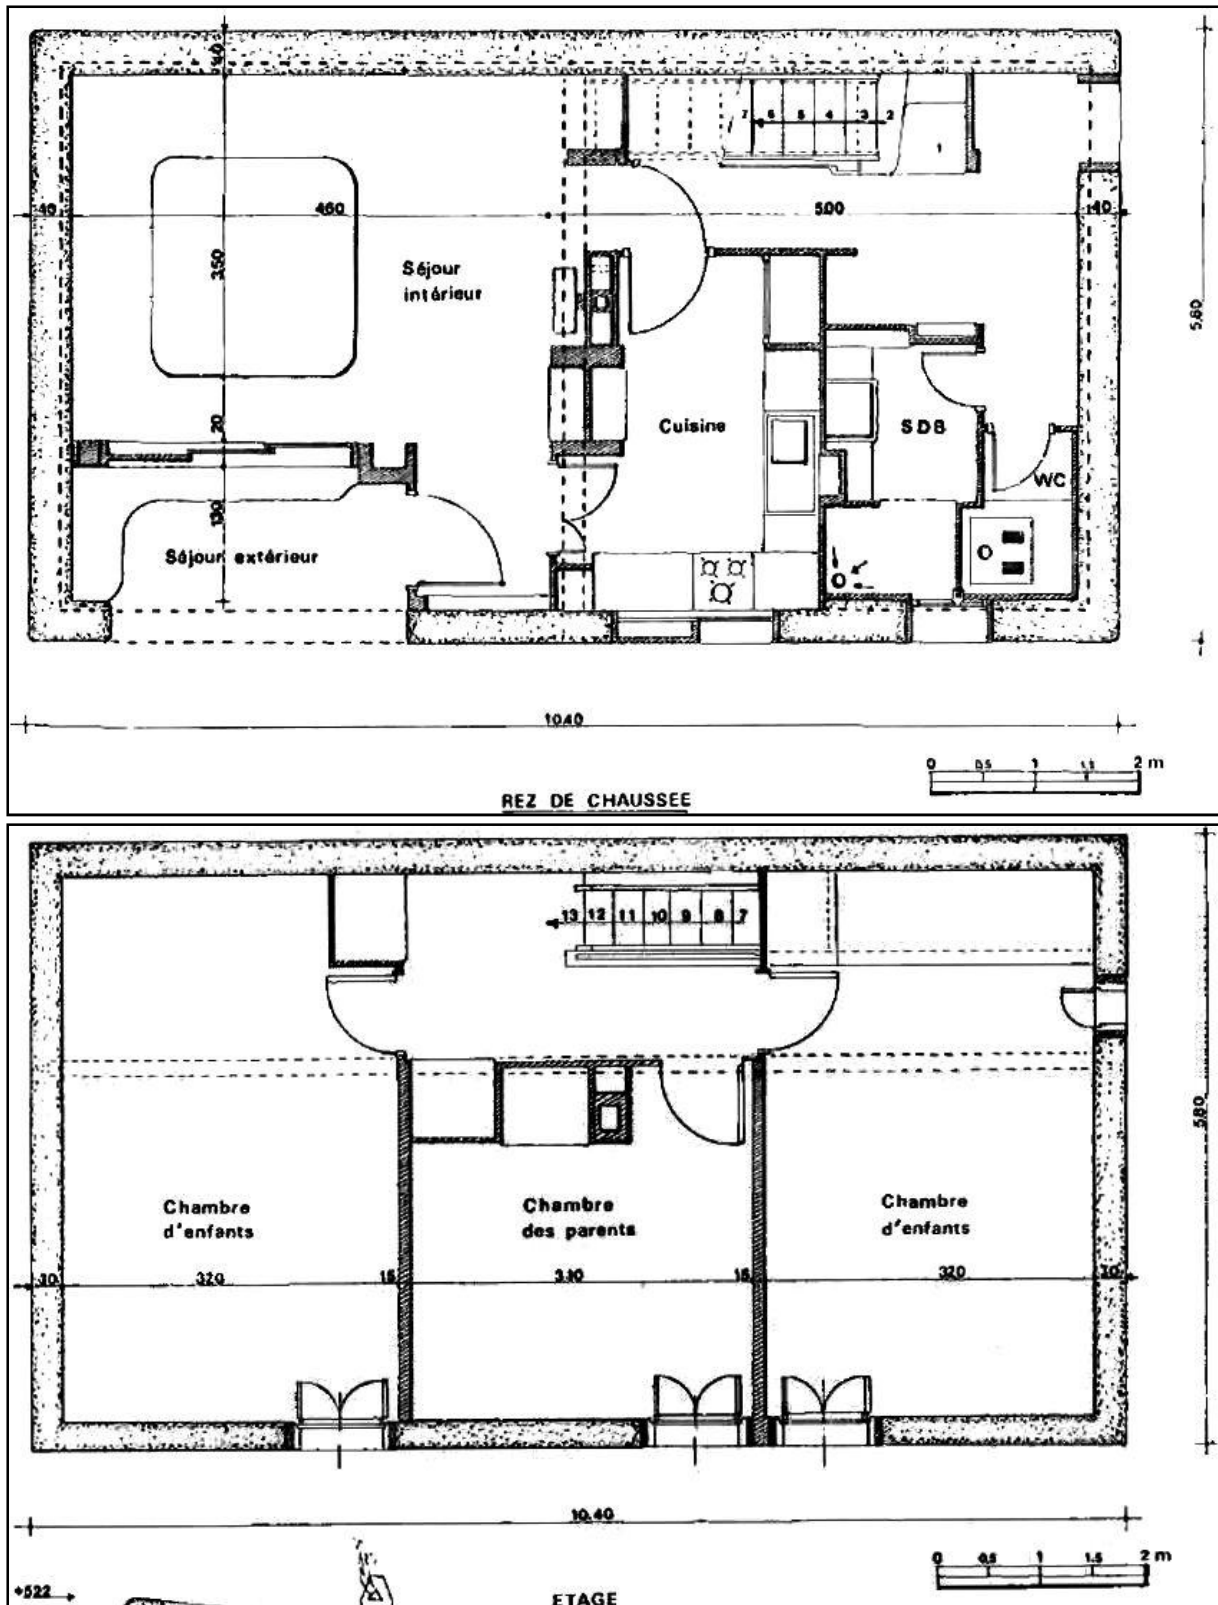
Plans types d'une construction en pisé au village Mostefa Ben Brahim [Doat et al, 1979].
